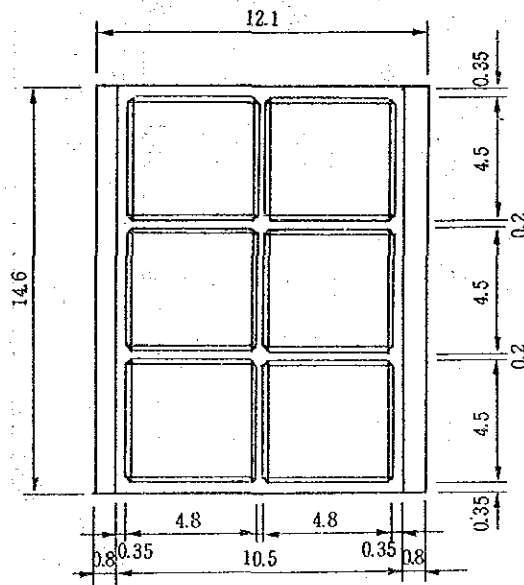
11.0M岸壁標準断面・平面図(L型ケーソン案)
